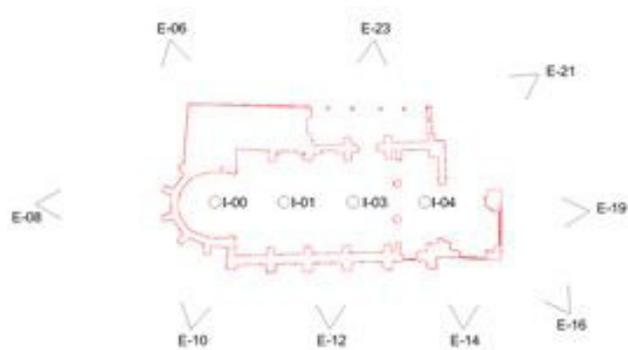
Planta con las tomas realizadas en el exterior (E) y en el interior (I)
